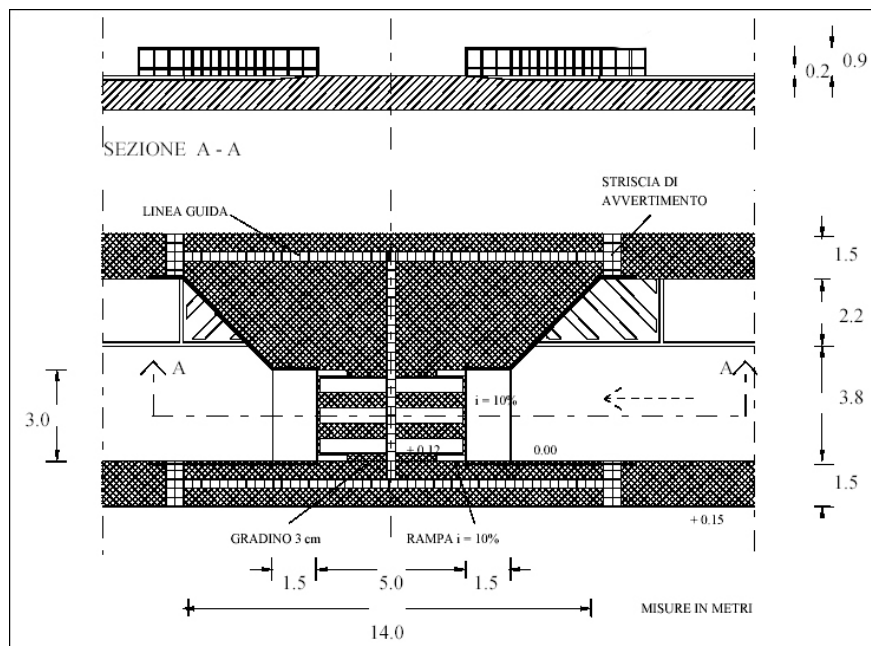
Schema di attraversamento pedonale rialzato proposto dalle *Linee guida per la redazione dei piani della sicurezza stradale urbana
